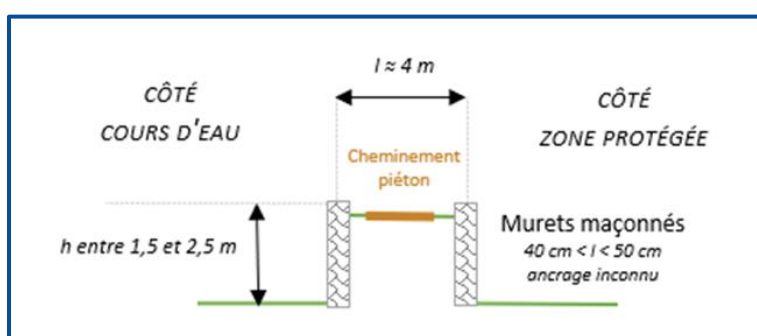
Coupe type du système d'endiguement de Lamothe – Tronçon 1 / Section c (T1c)
